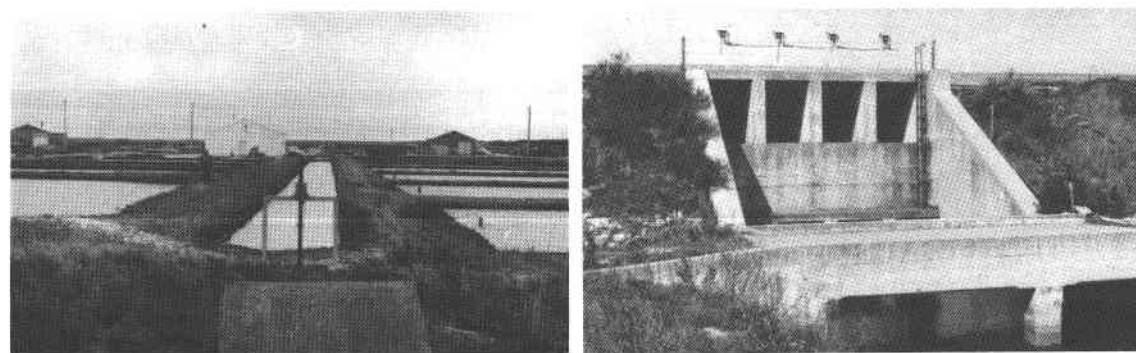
et 6. — A gauche, canal secondaire alimentant les claires situées de part et d'autre; au premier plan, la vanne de remplissage de ce canal (photo Robert). A droite, écluse d'évacuation des eaux sur l'estran (photo Dréno).
